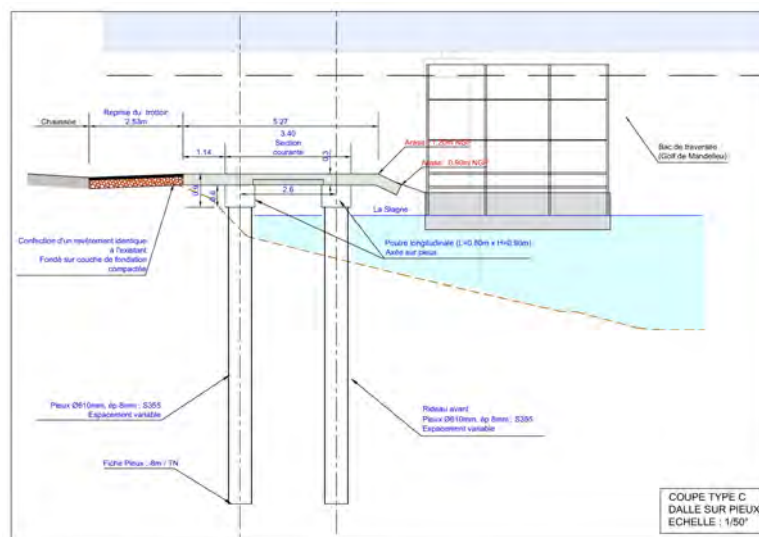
RAPPEL DE LA COUPE TYPE ZONE AMONT DU PONT SNCF
